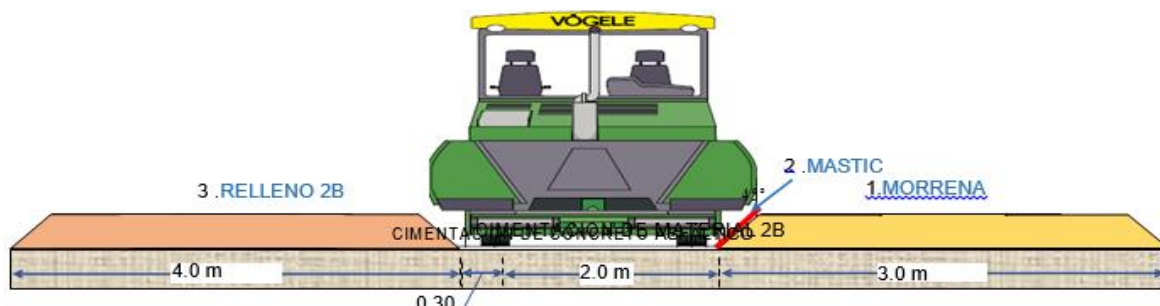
Posicionamiento de pavimentadora en el tramo de 2.30m de ancho.
